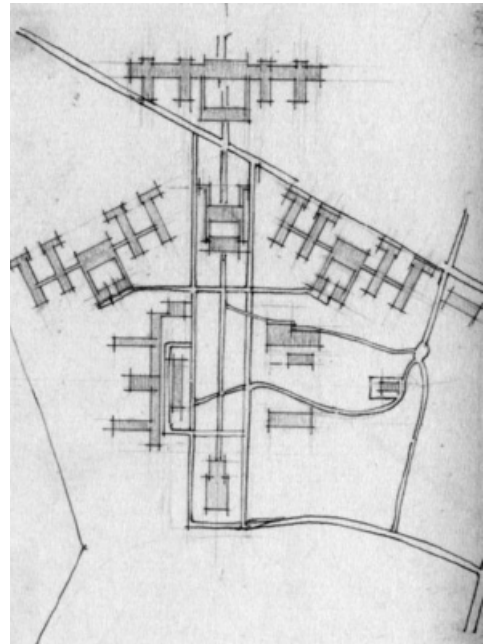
Sanatorio de Zonnestraal. Primera propuesta aprox. 1919. Dibujo de la planta a escala 1/100 (Meurs, Thoor 2010: 78).
